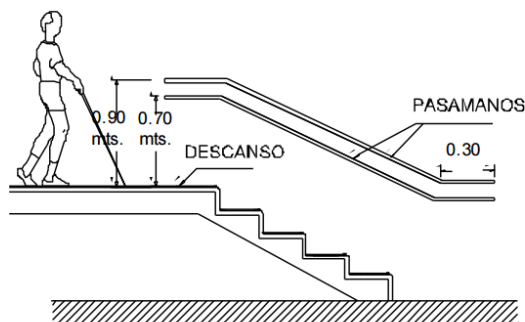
Detalle en elevación de pasamanos. Fuente: sitio web.
